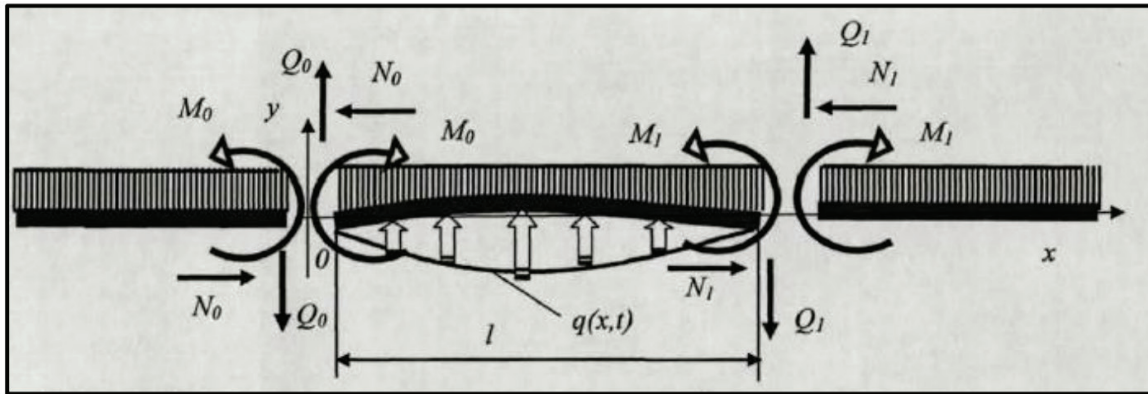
Расчетная схема подземного трубопровода при поперечных подвижках грунта в процессе землетрясения
